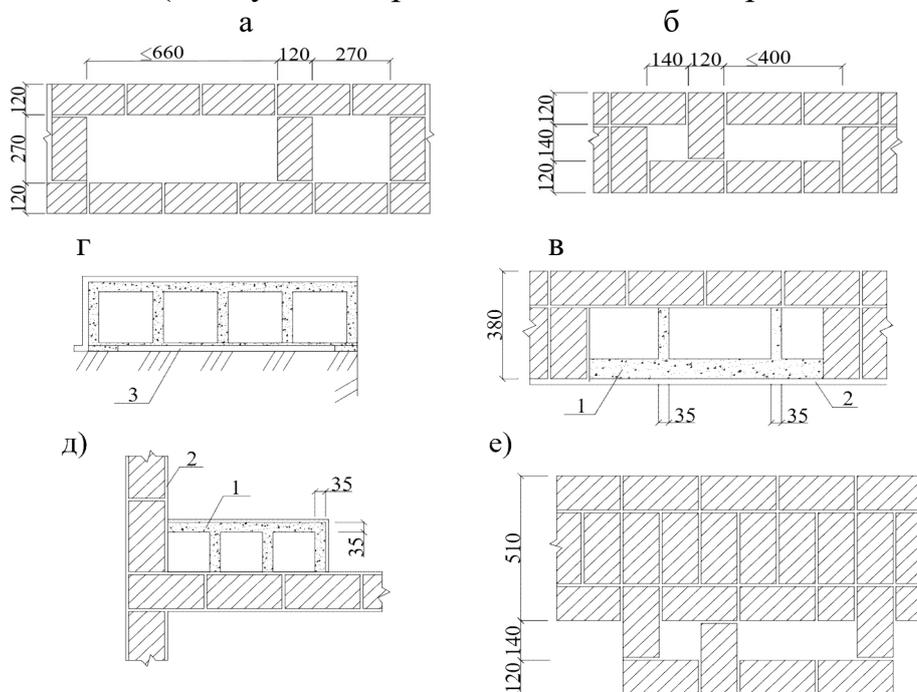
Устройство вентиляционных каналов в каменных стенах:
